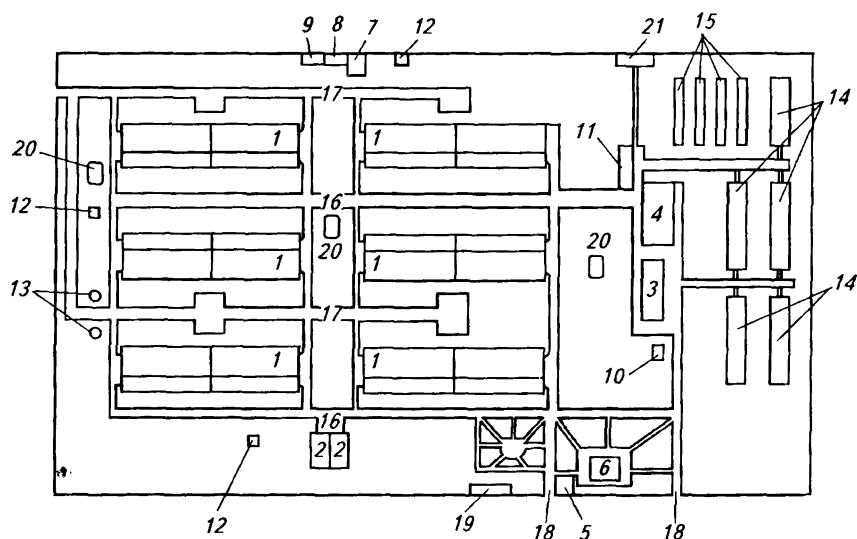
Генеральный план кроликофермы на 1800 основных и 720 проверяемых маток:
